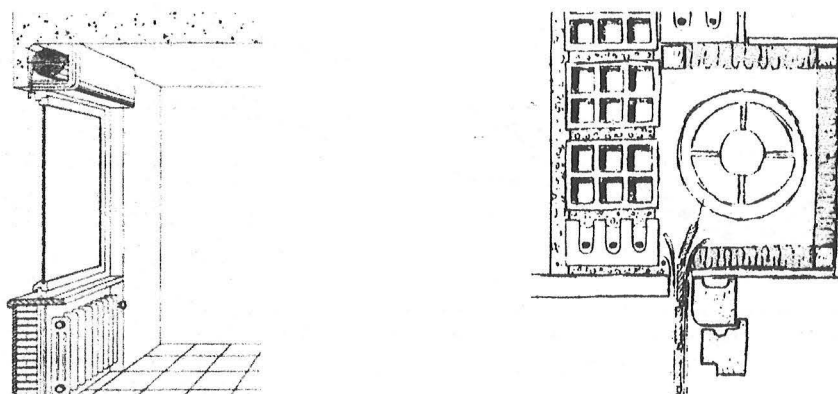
Vista de los elementos de menor aislamiento a ruido aéreo en una fachada
